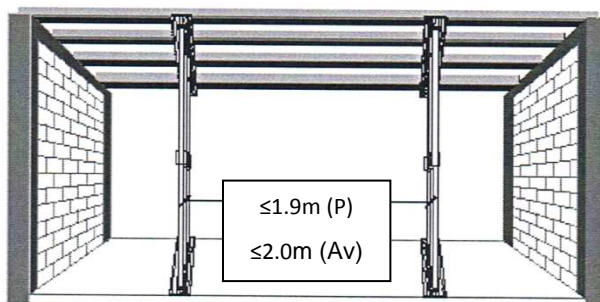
Escoramento dos pavimentos durante a fase de execução
